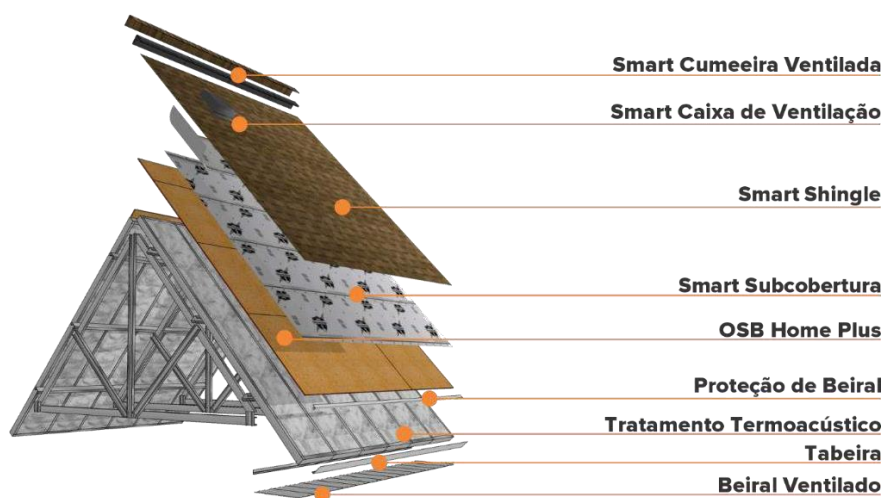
sistema de construção do telhado shingle, conforme estrutura da residência steel frame
